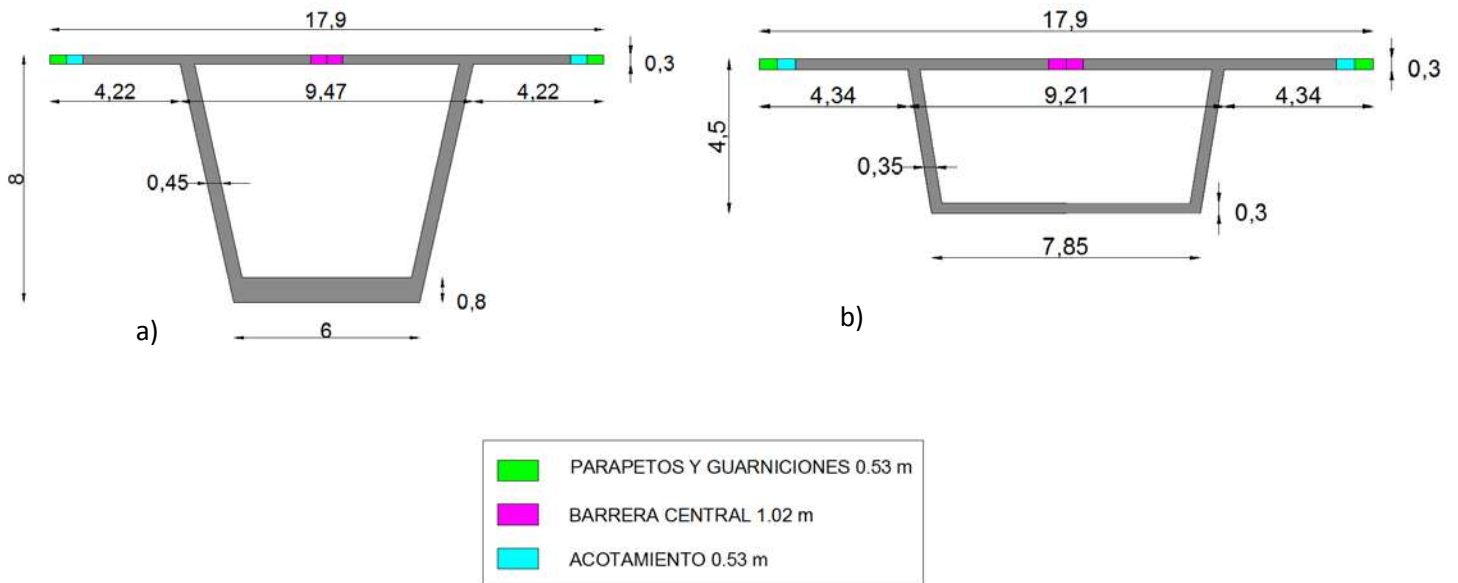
e Secciones cajón utilizadas en el modelo del puente tipo. a) Cerca de la pila, b) A la mitad del claro. Cotas en metros.
